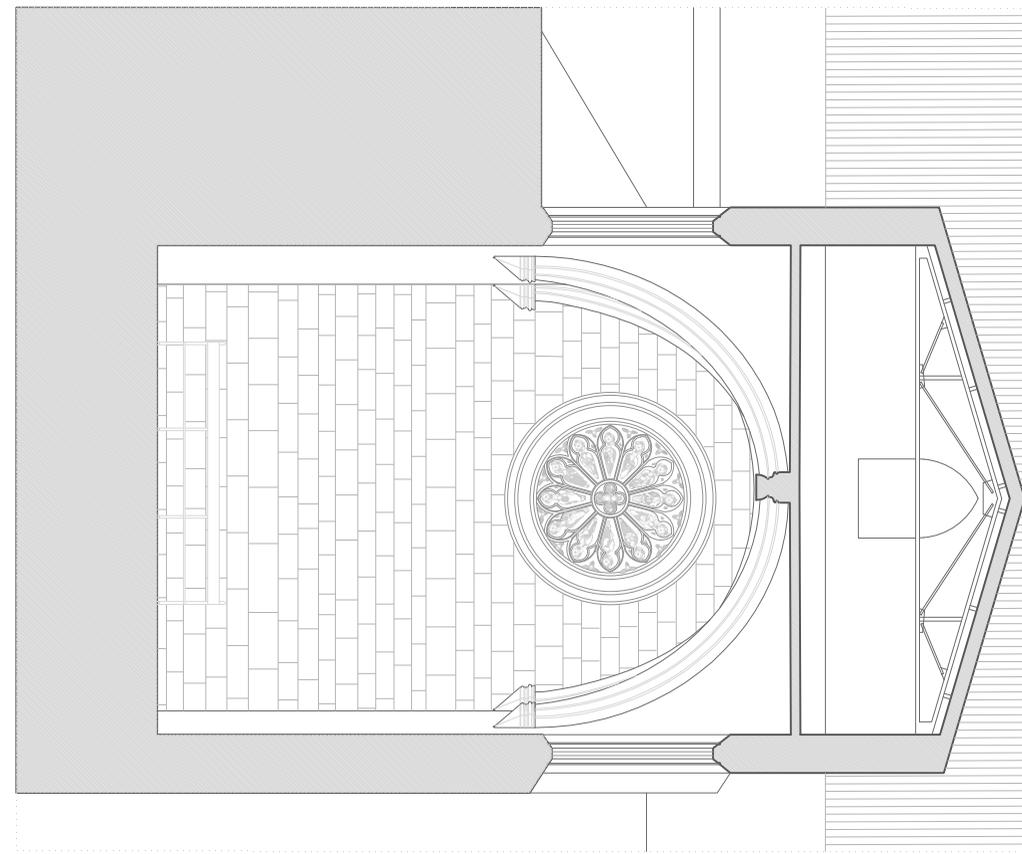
Planta a cota +6.14 y sección transversal por delante del rosetón. Escala 1:100. [Dibujo propio, 2019]
